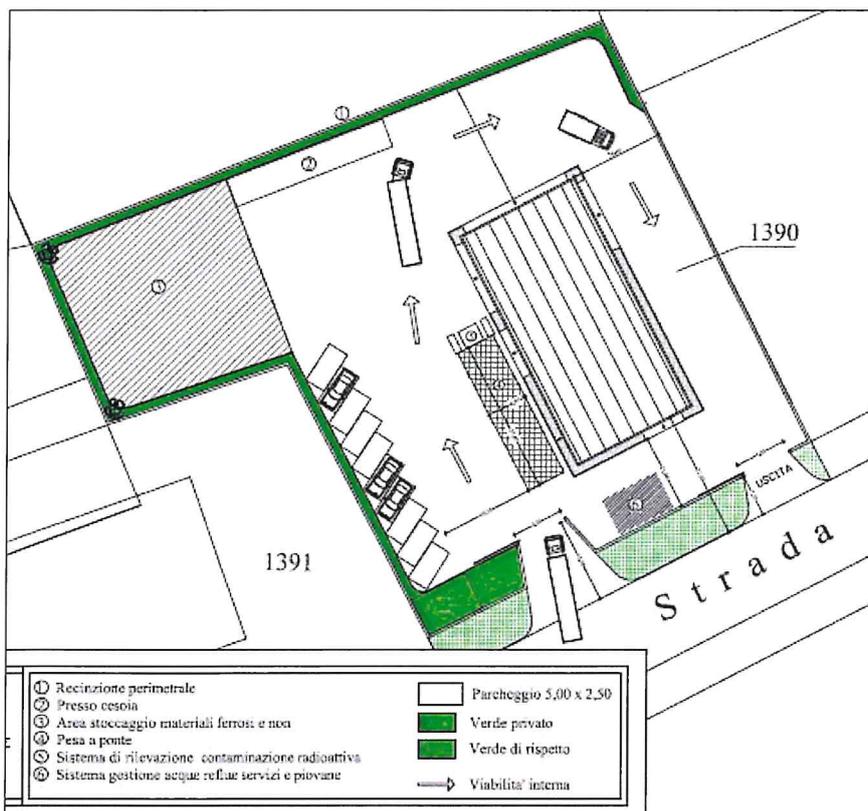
Layout impianto (allegato al progetto esaminato con giudizio 1892/2011)
